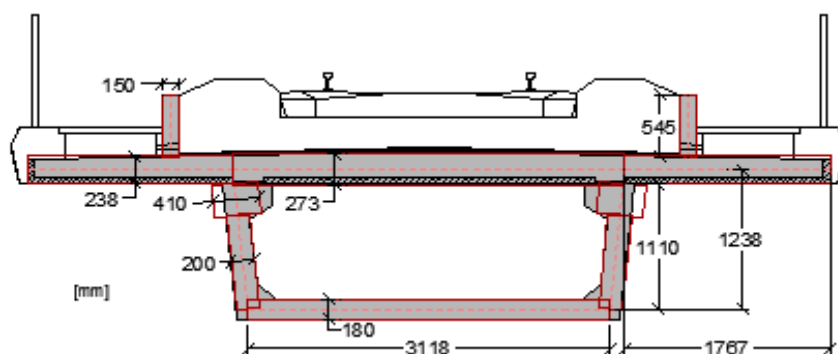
Espessuras (mm) da viga pré-fabricada, da laje betonada *in situ* e dos guarda-balastro, adotadas no modelo numérico
